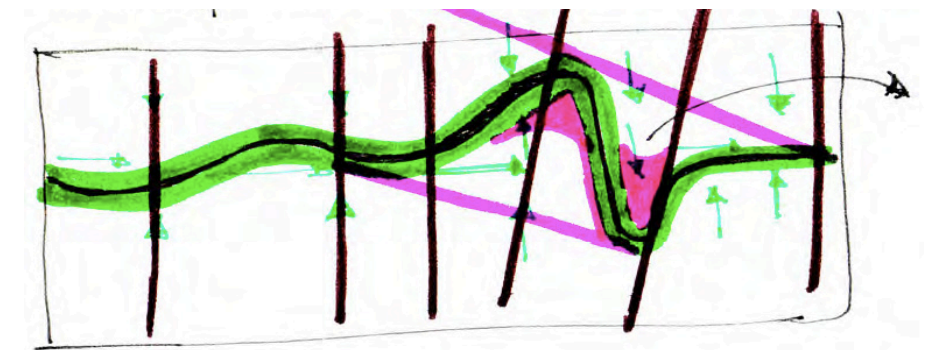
Esquema de implantación en planta , fuente: esta investigación
